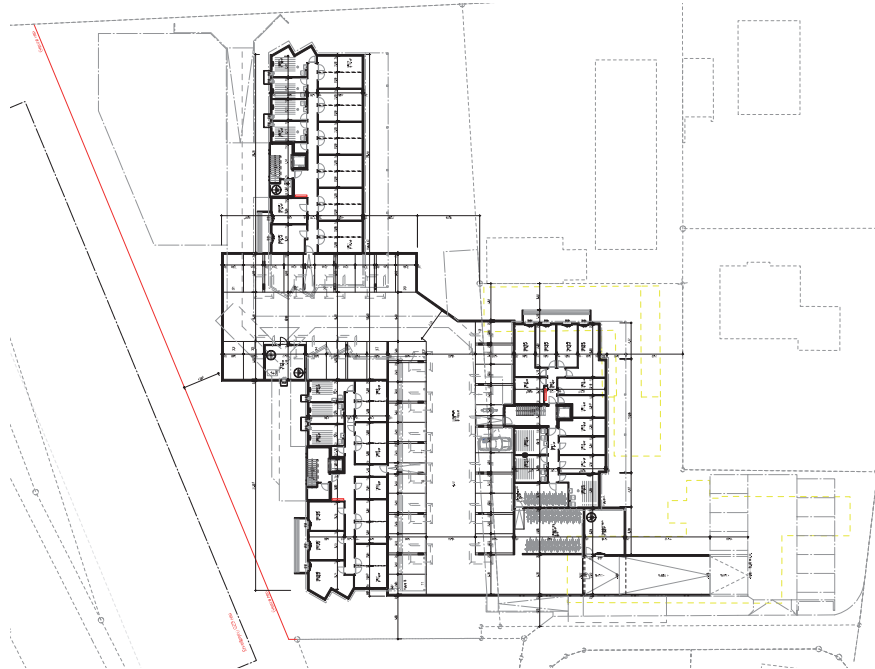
Bebauungskonzept Löffel + Bänziger AG, Grundriss UG / Einstellhalle
